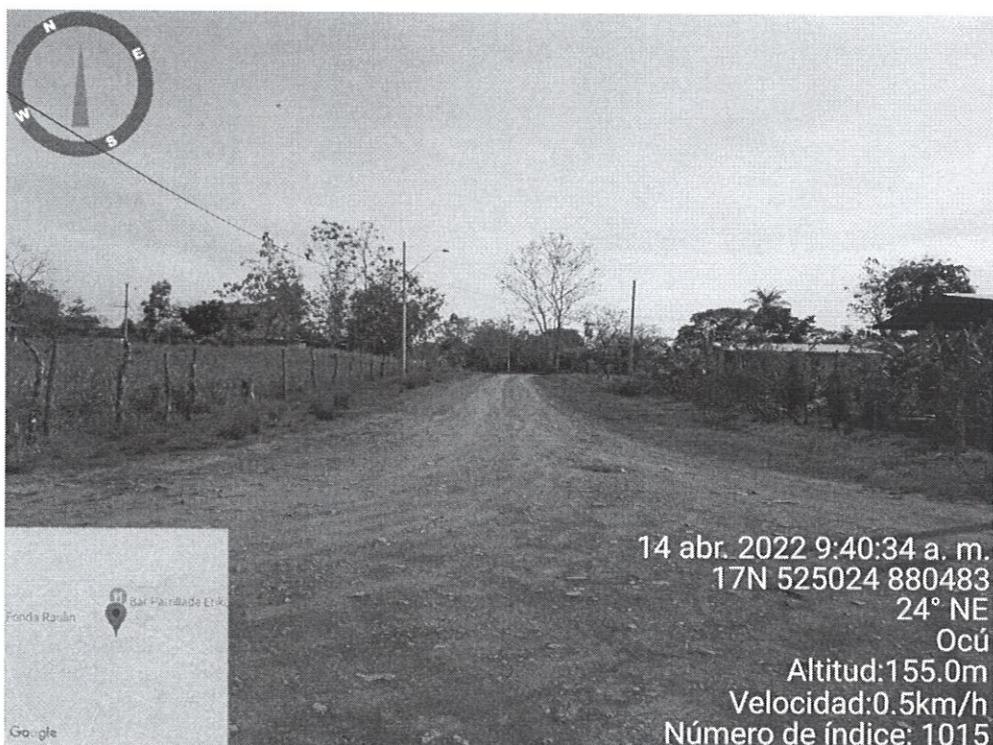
Vista de la topografía del proyecto, se observa la parcelación de lotes y la construcción de las calles.
